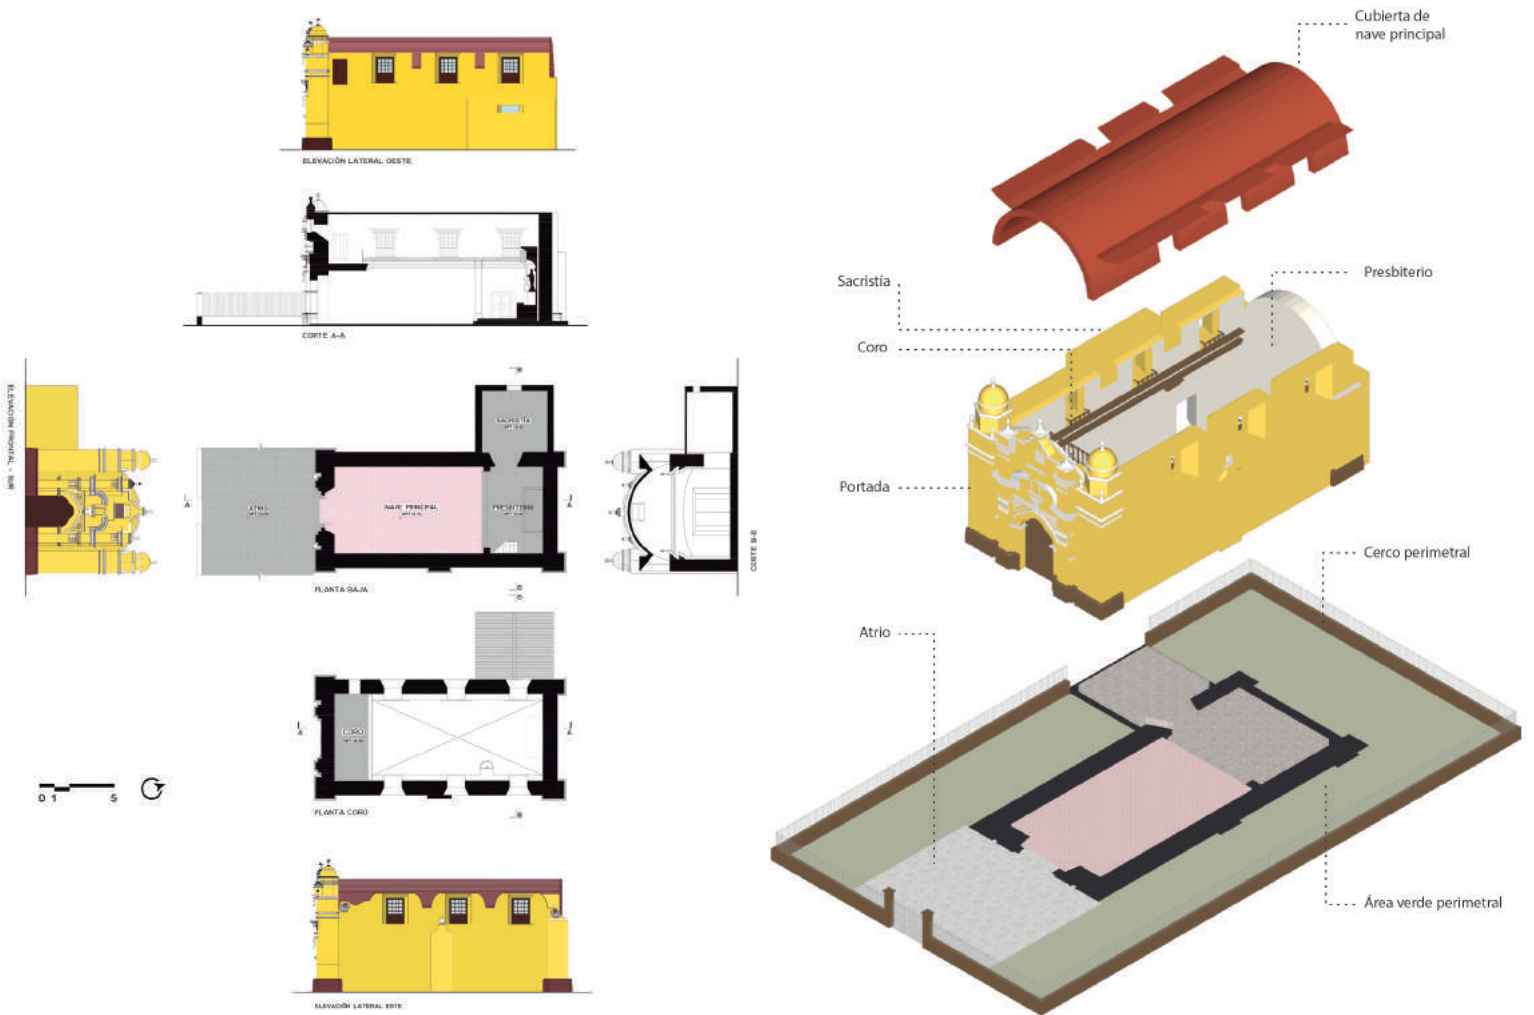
Planimetría y axonometría explotada de la capilla de la ex Hacienda Maranga.
